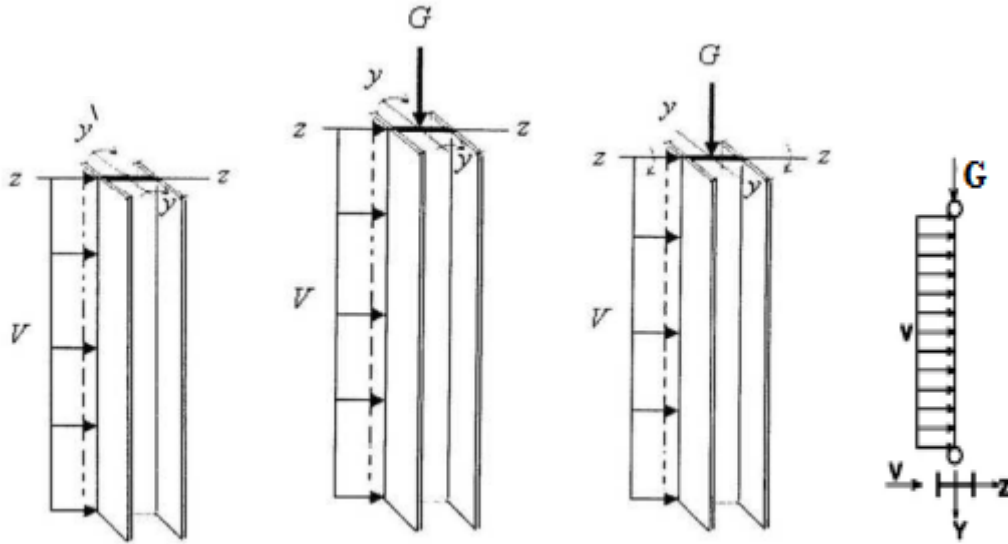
17 : Les différents plans de chargement d'un potelet.
